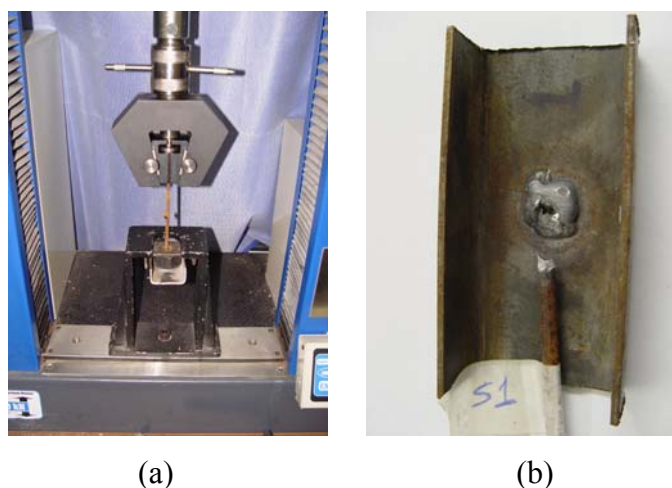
(a) Ensaio à tração na ligação soldada (armadura-perfil) e (b) ruptura da ligação no CP1
